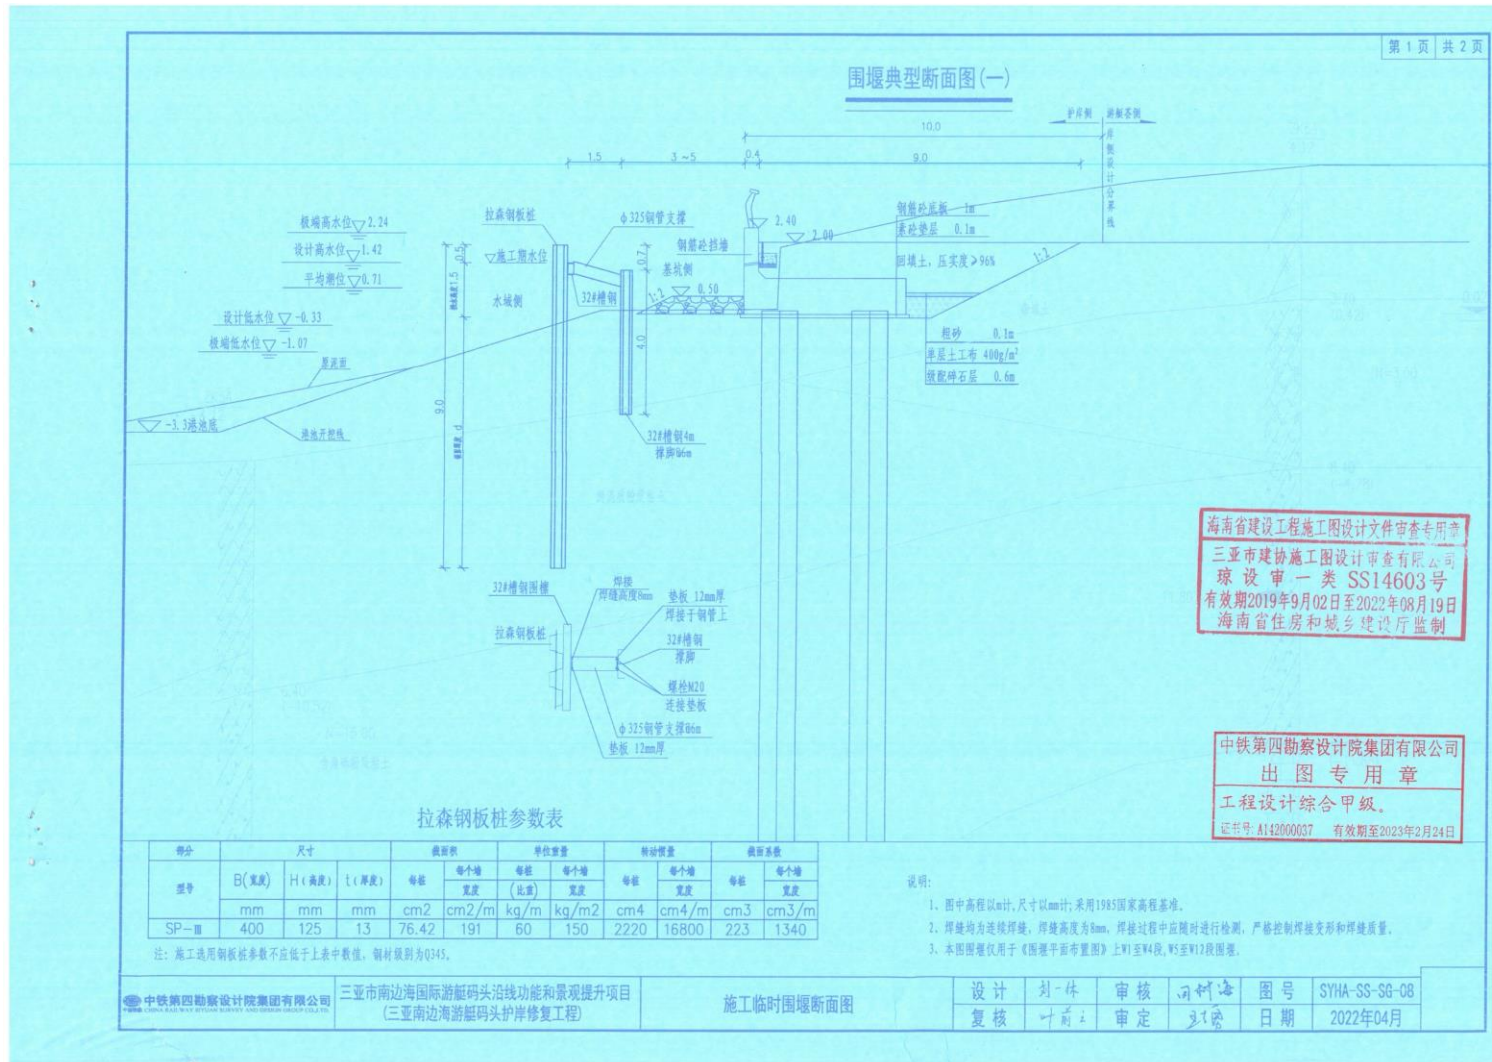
施工临时围堰断面图（适用于 W1~W4、W5~W12 段围堰）
